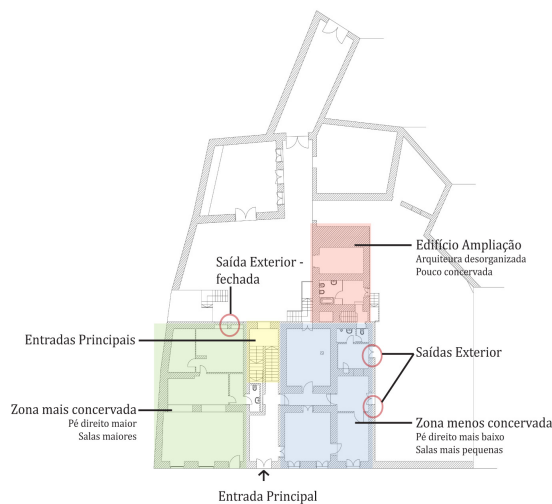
Planta original, Piso 0, com zonamento e identificação de locais relevantes
